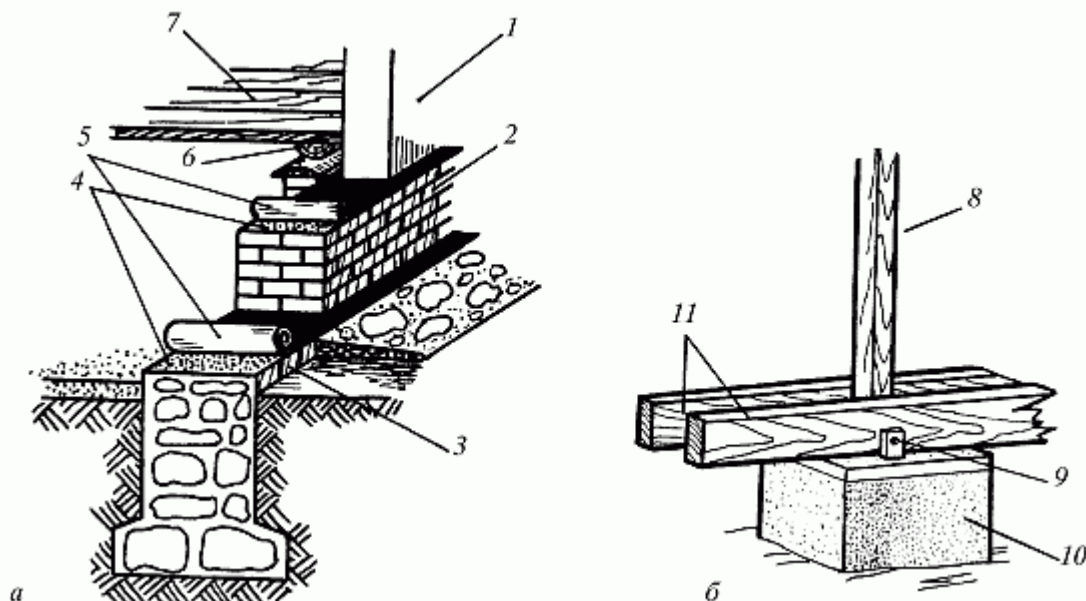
Виды фундаментов: а – ленточный; б – столбчатый; 1 – стена; 2 – цоколь; 3 – отмостка; 4 – раствор цемента; 5 – гидроизоляционный материал; 6 – лага; 7 – пол; 8 – стойка; 9 – анкер; 10 – столб; 11 – лаги
